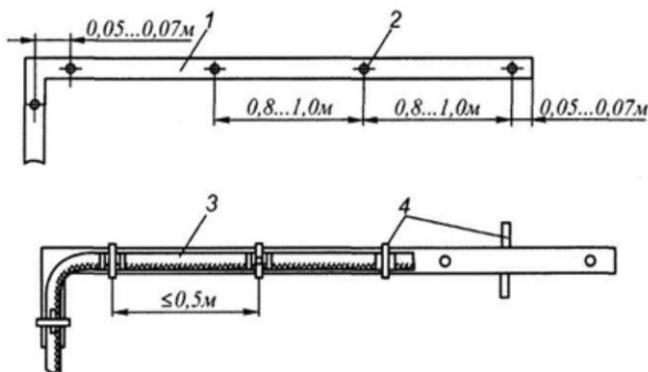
Крепление кабелей на стальных полосах и лентах:
